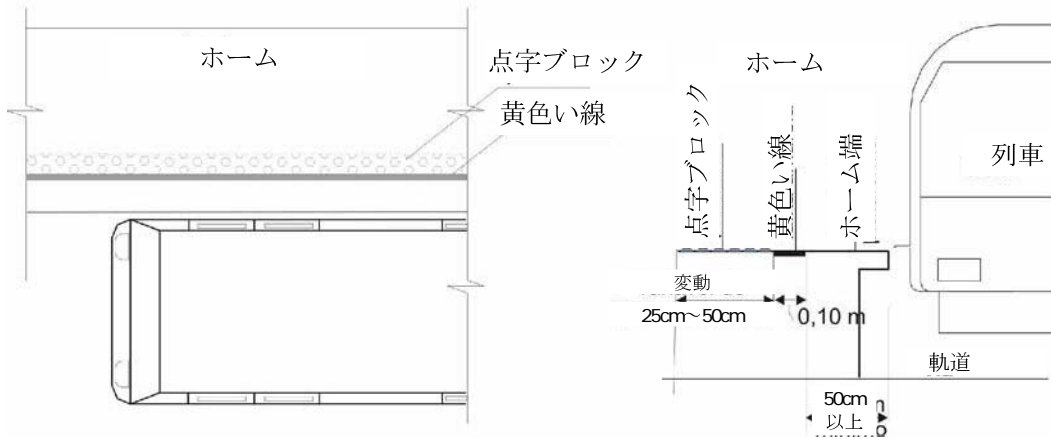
ホームの端の黄色線と警告ブロック（平面図、断面図）
